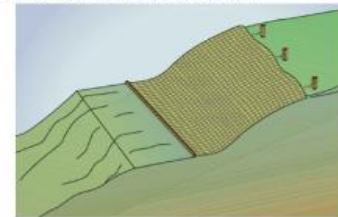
Escavação protegida - com estruturas de madeira "verticais"
